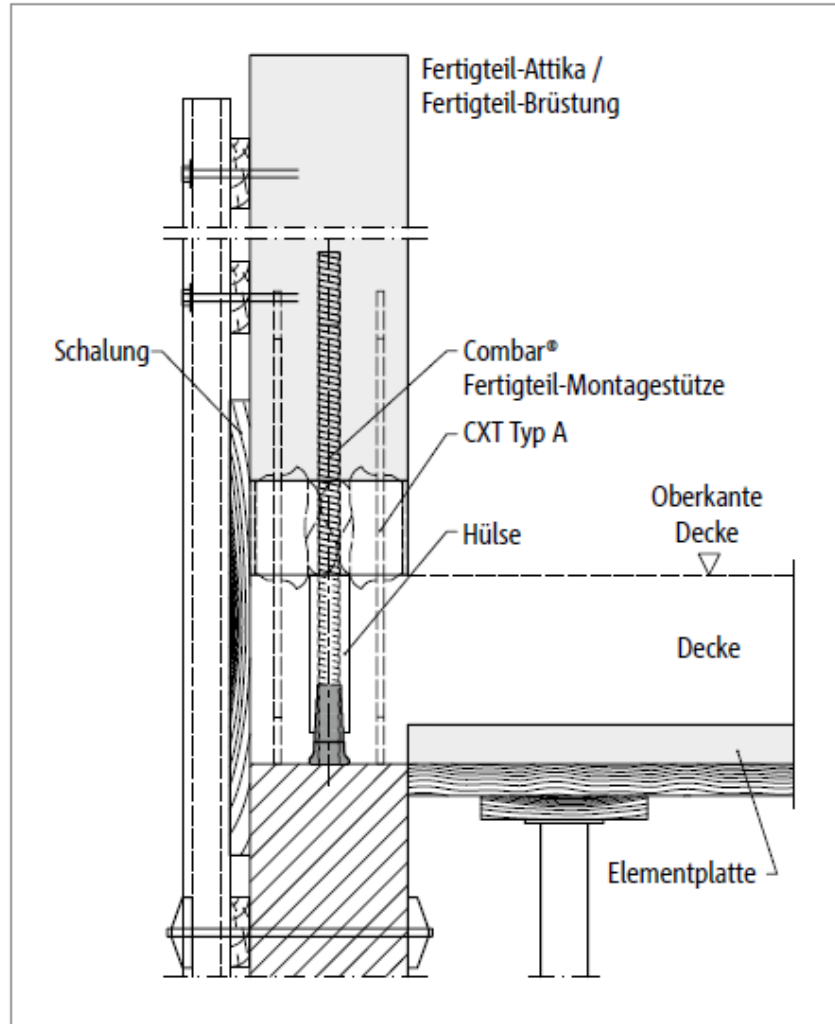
Schöck Isokorb® CXT Typ A: Anschluss einer Brüstung
